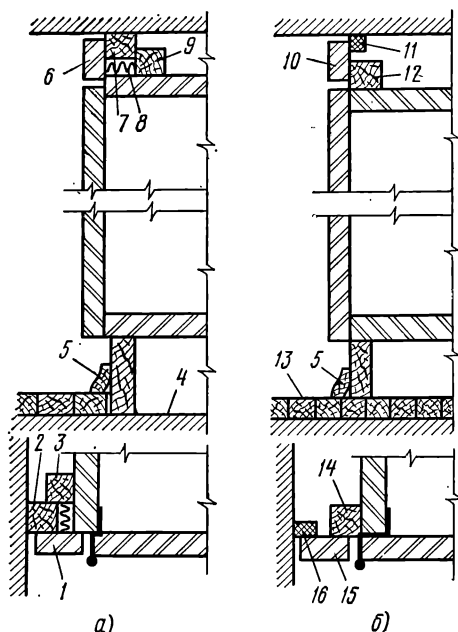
Схема примыкания шкафа-перегородки к элементам зданий:
